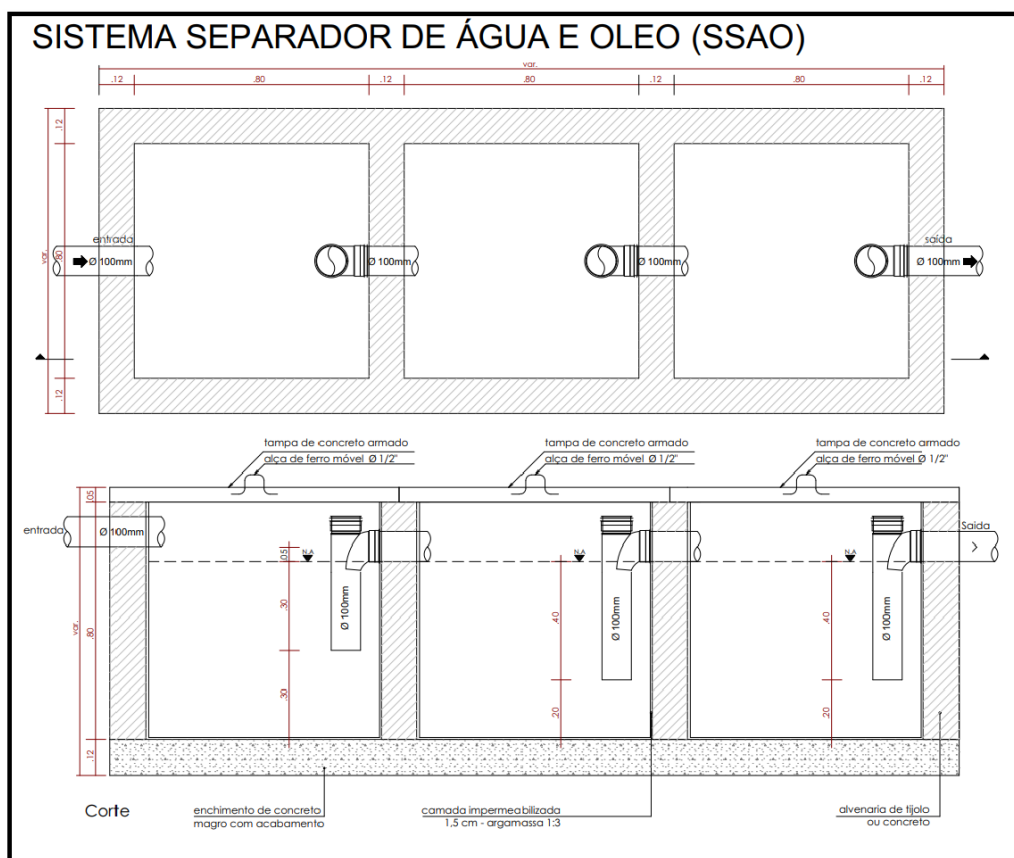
Croqui SSAO. Fonte: Projeto hidro sanitário.
